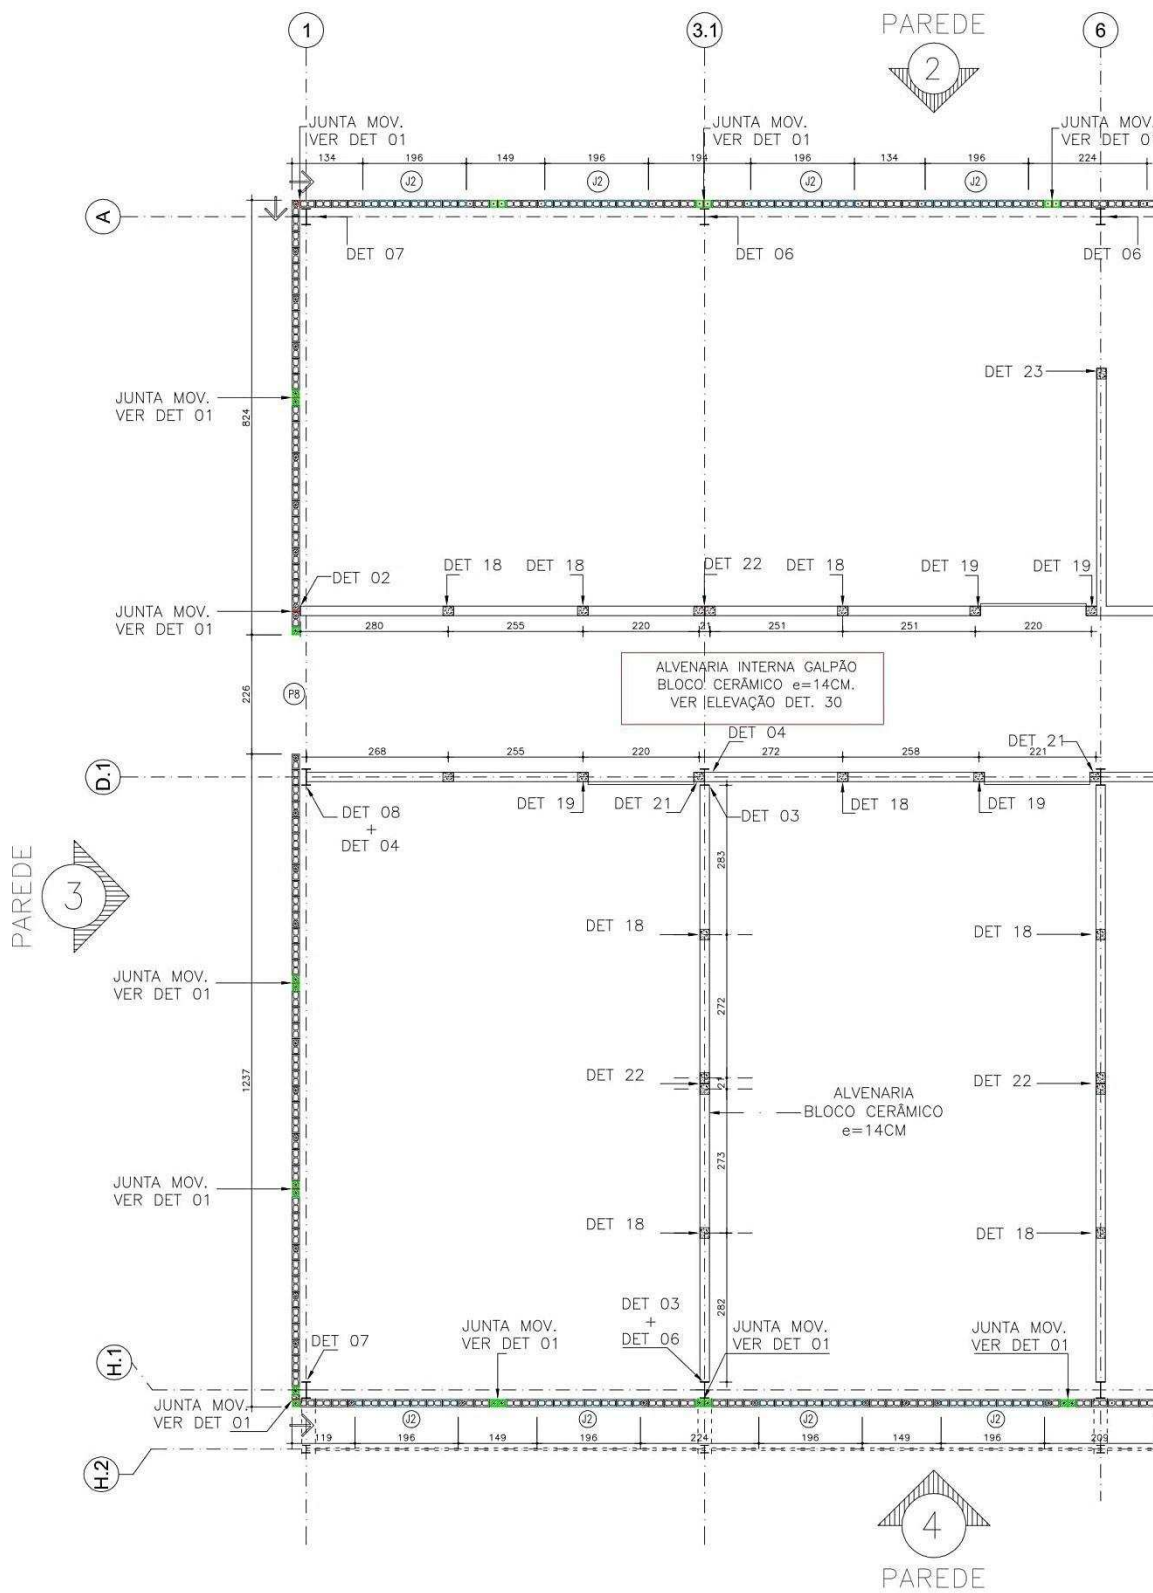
Planta parcial do pavimento 01 integrante do projeto de alvenaria do LBE.
